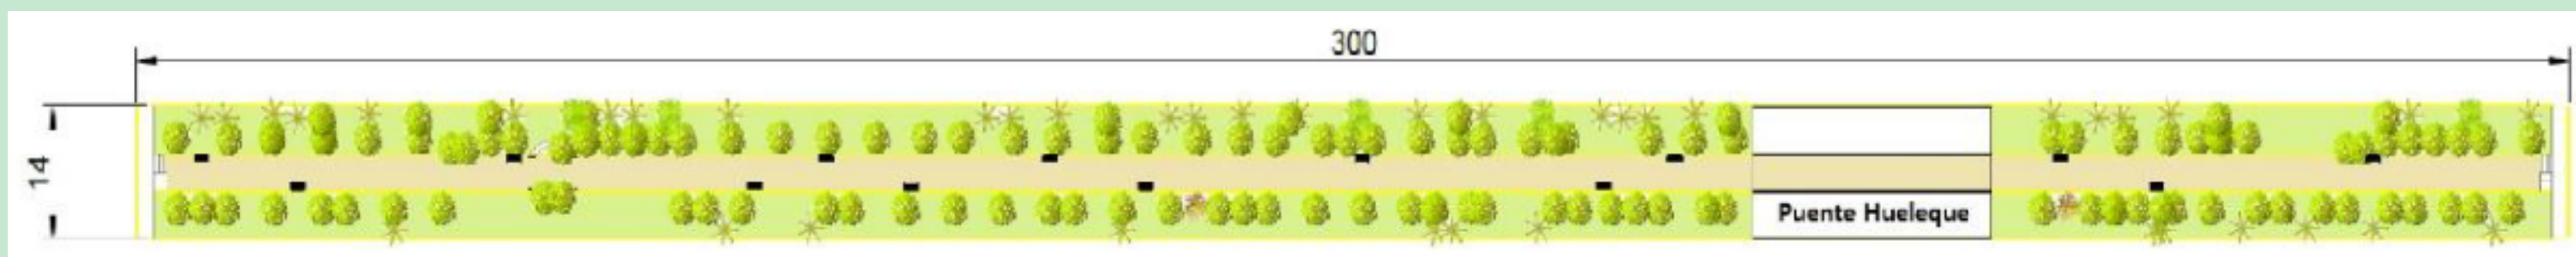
Plano vista en planta de la sección 2 del camellón ubicado en el boulevard Adolfo Ruíz Cortínes.
